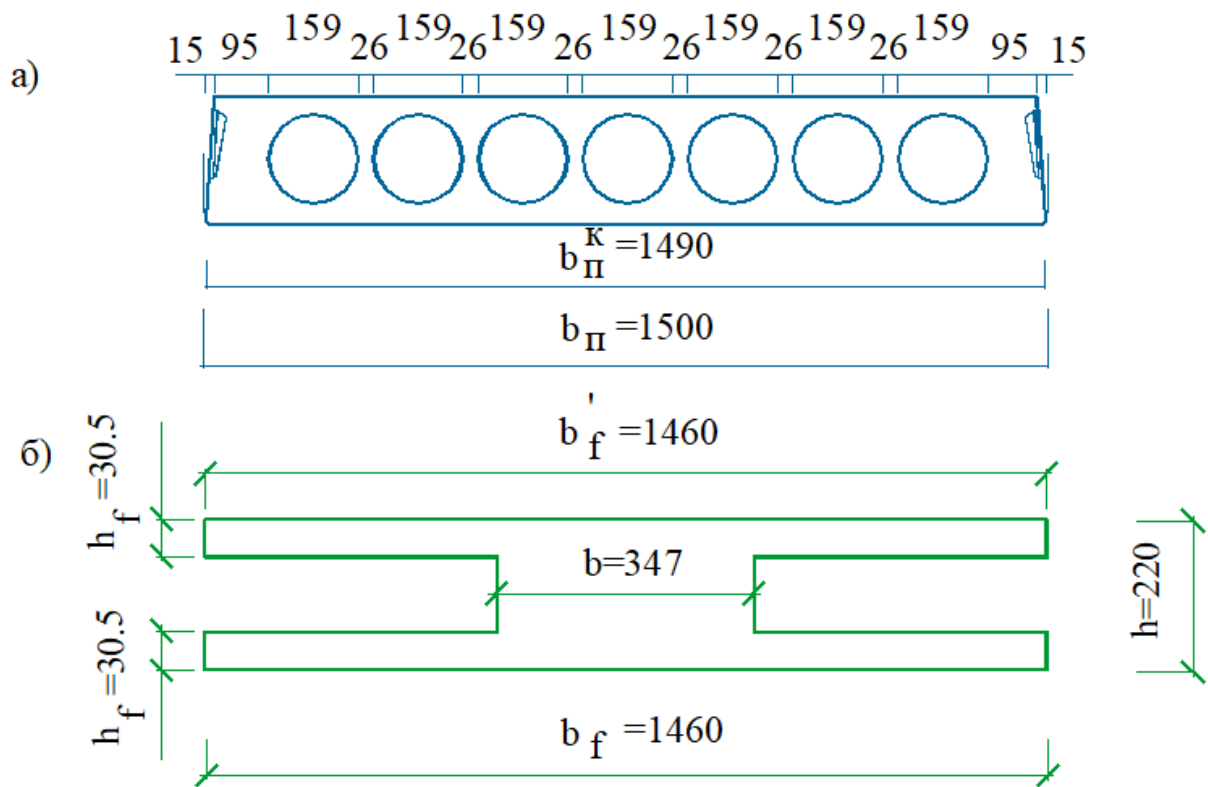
Поперечний переріз багатопустотної плити перекриття
